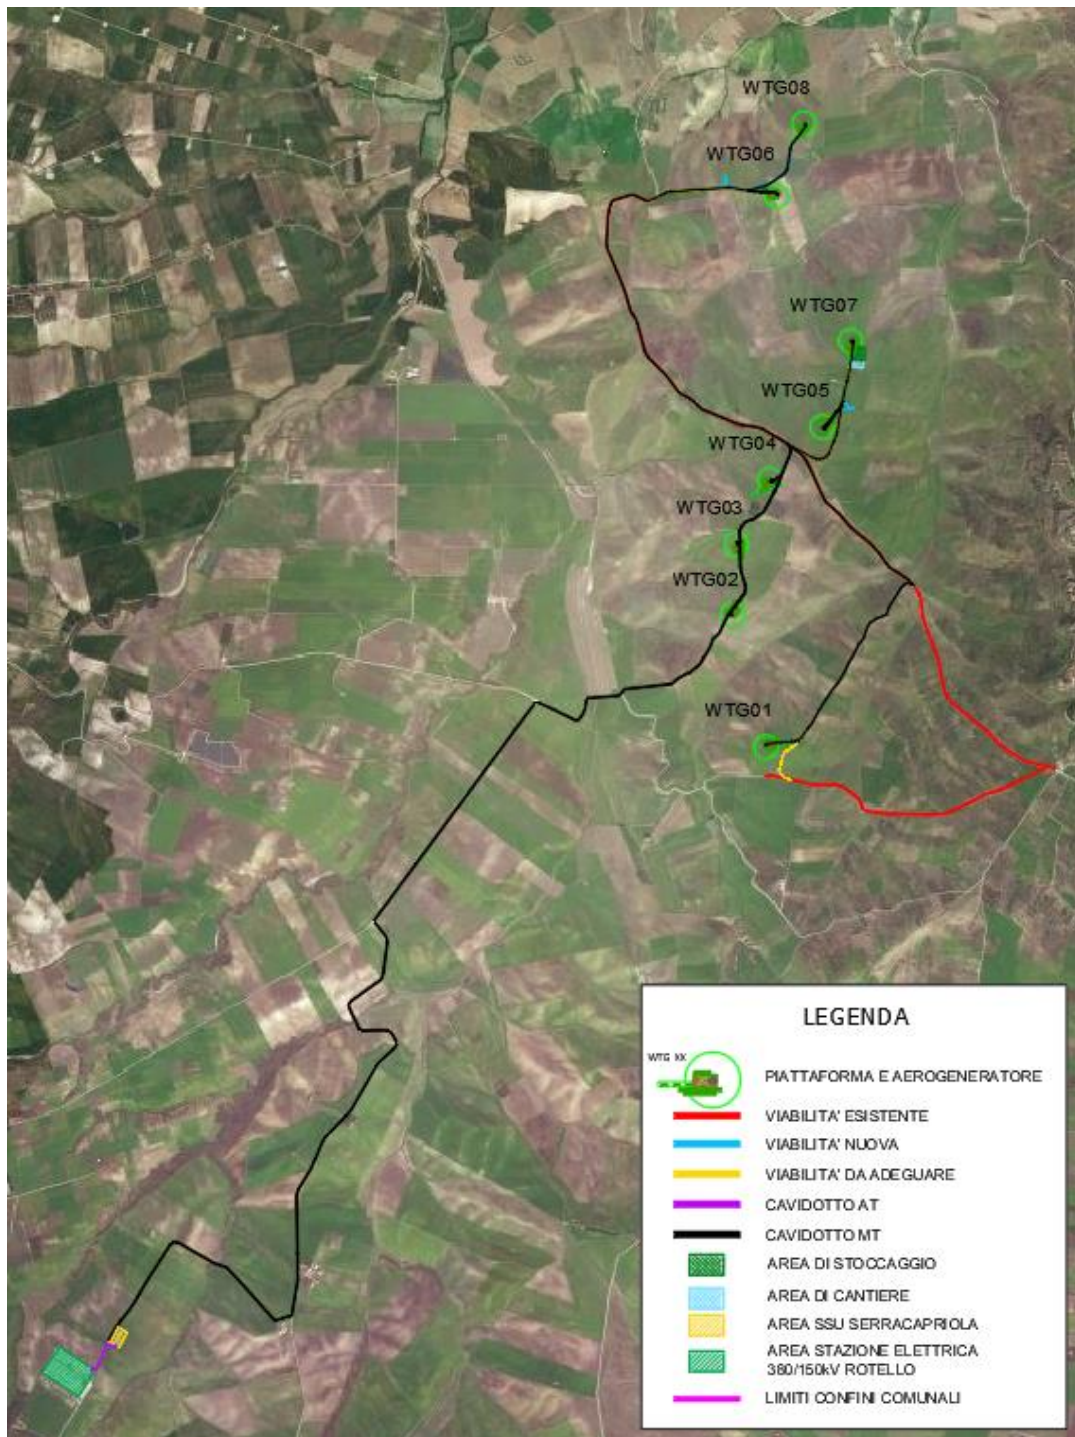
Individuazione su ortofoto dell'impianto in progetto
